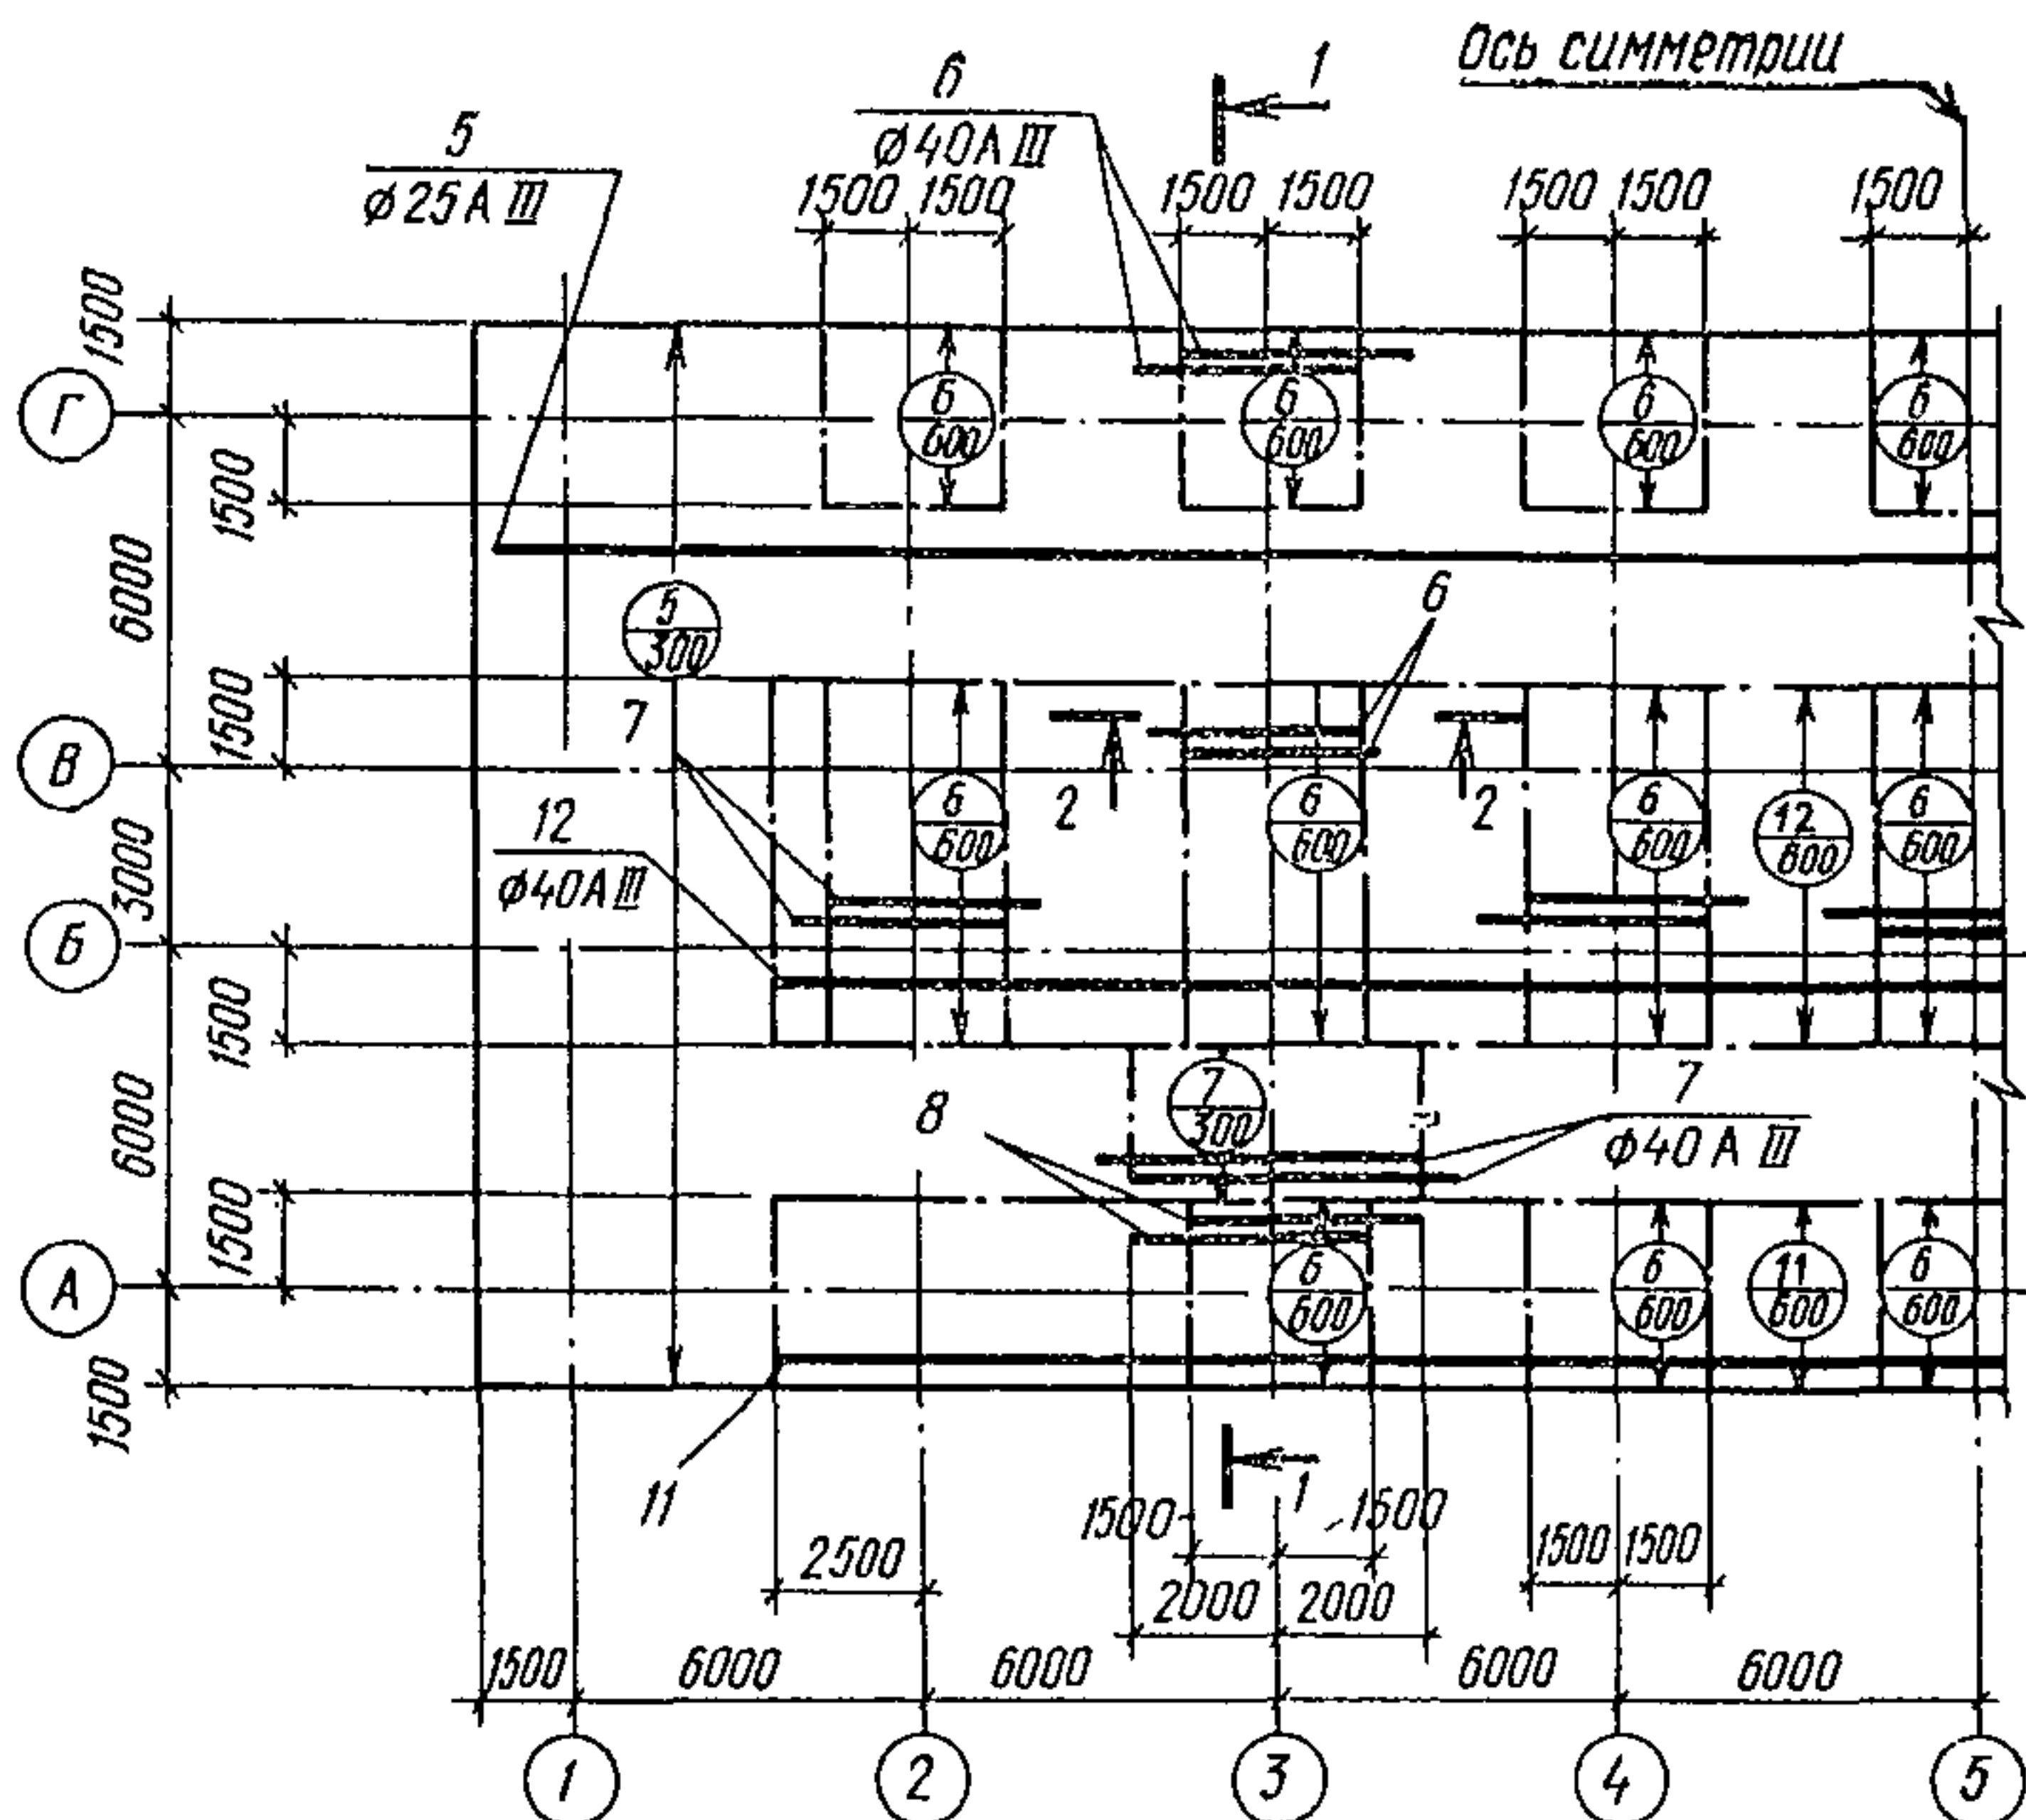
План раскладки арматуры второго слоя нижней зоны
